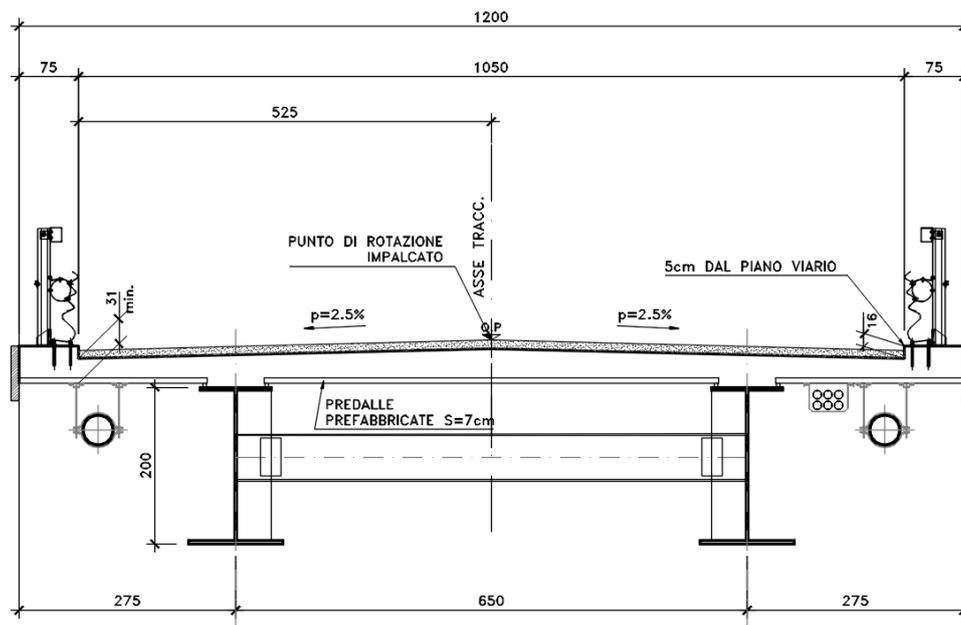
Sezione trasversale impalcato in campata tipo a 2 travi
